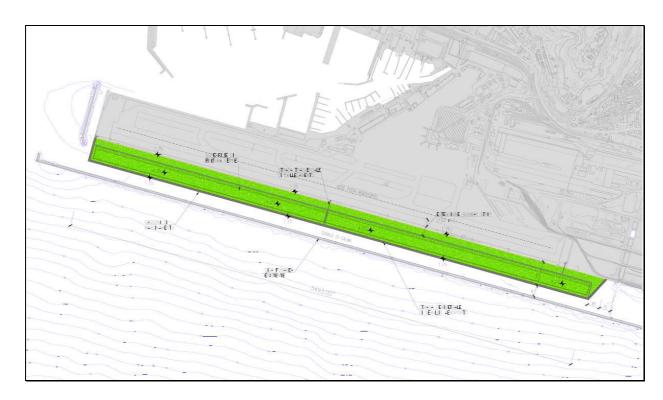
Opera a Mare nel Canale di Calma - Planimetria Generale degli interventi [5]
